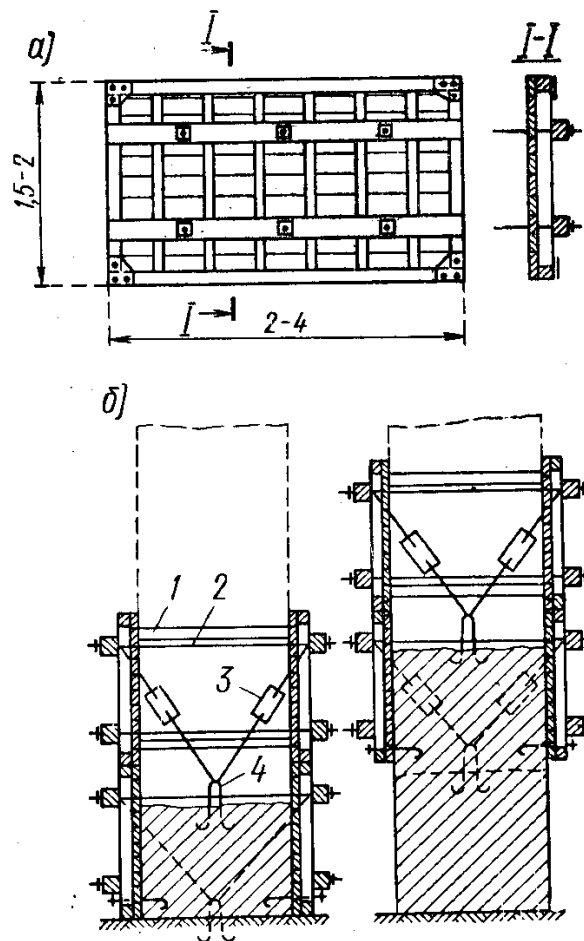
Конструкція щитової опалубки: а - конструкція щита; б – схема перестановки щитів: 1 - розпірка; 2-тяж; 3 - стяжна муфта; 4 - петля
